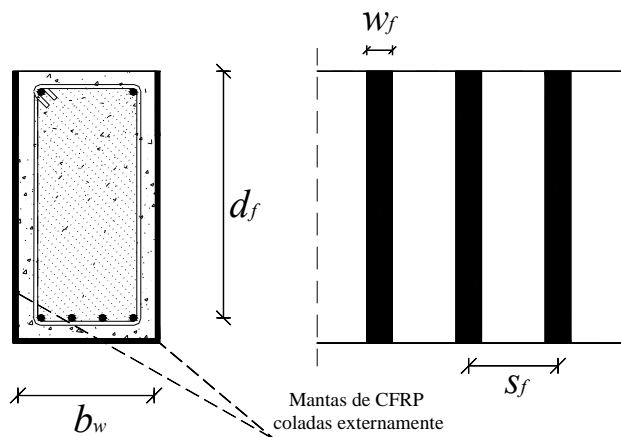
Reforço ao corte com faixas discretas de manta de CFRP coladas externamente.
